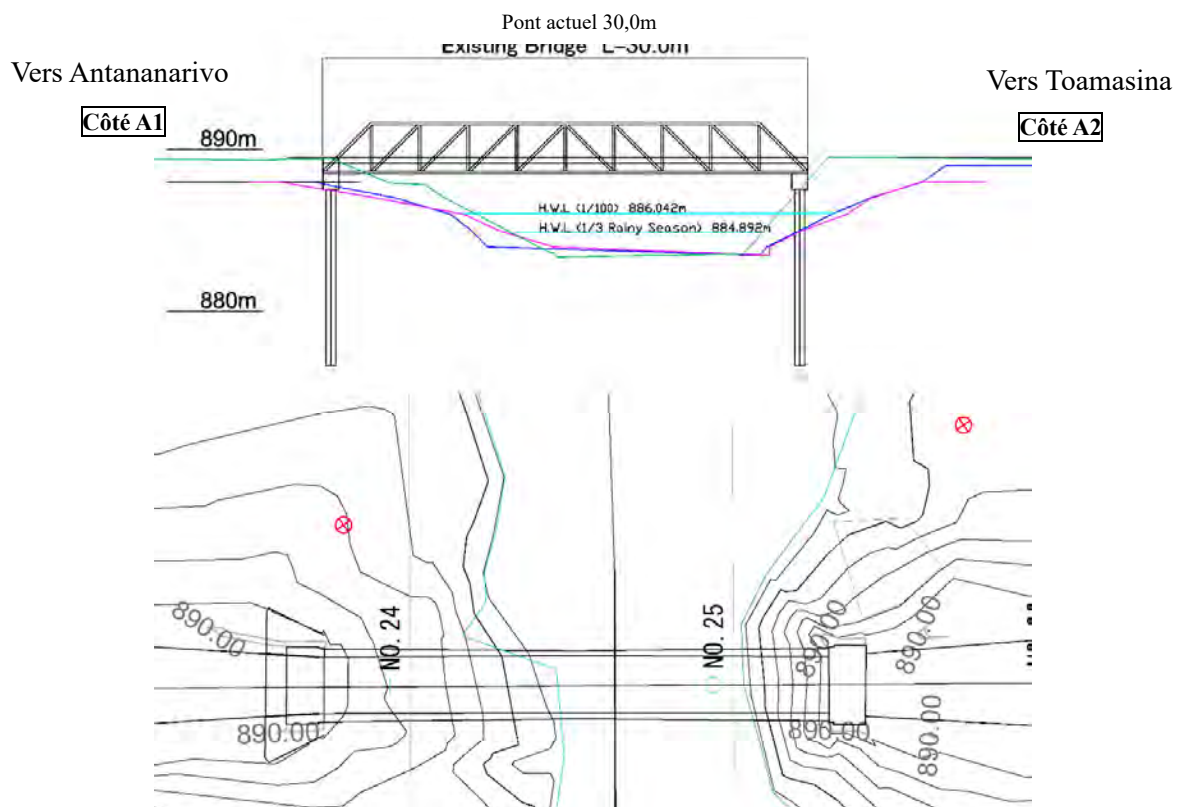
Profil en travers du cours d'eau de l'emplacement du pont et vue en plan
